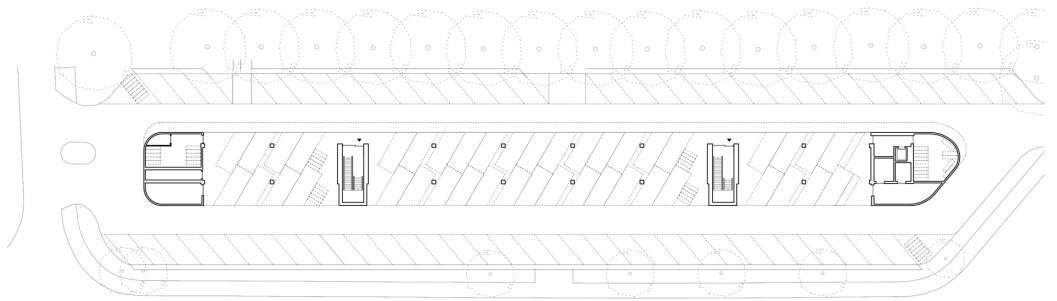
Wohnen am Dantebad 1, Grundriss Erdgeschoss. Florian Nagler Architekten, 2016.
